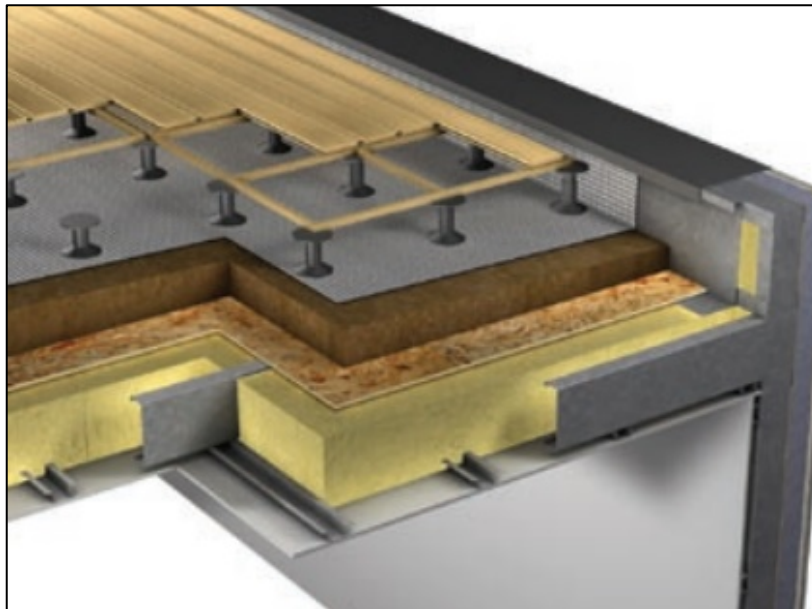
Piso Tipo Terraza con Pavimento Flotante
